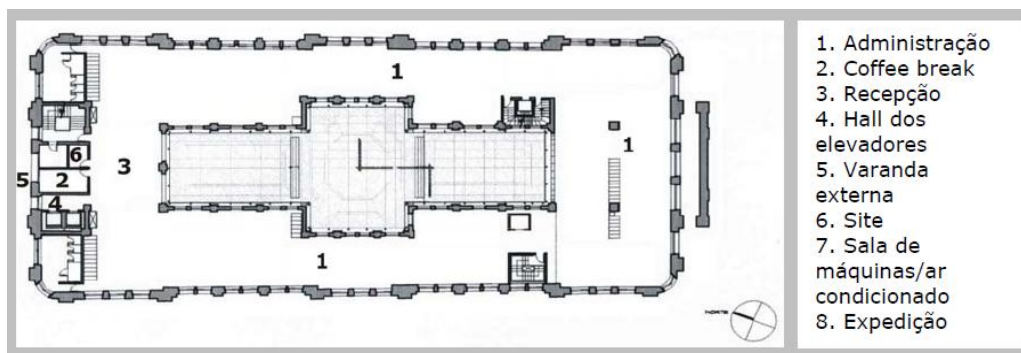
Planta baixa Santander Cultural, 2º pavimento/ Átrio Central. Fonte: TAVARES, 2007.
